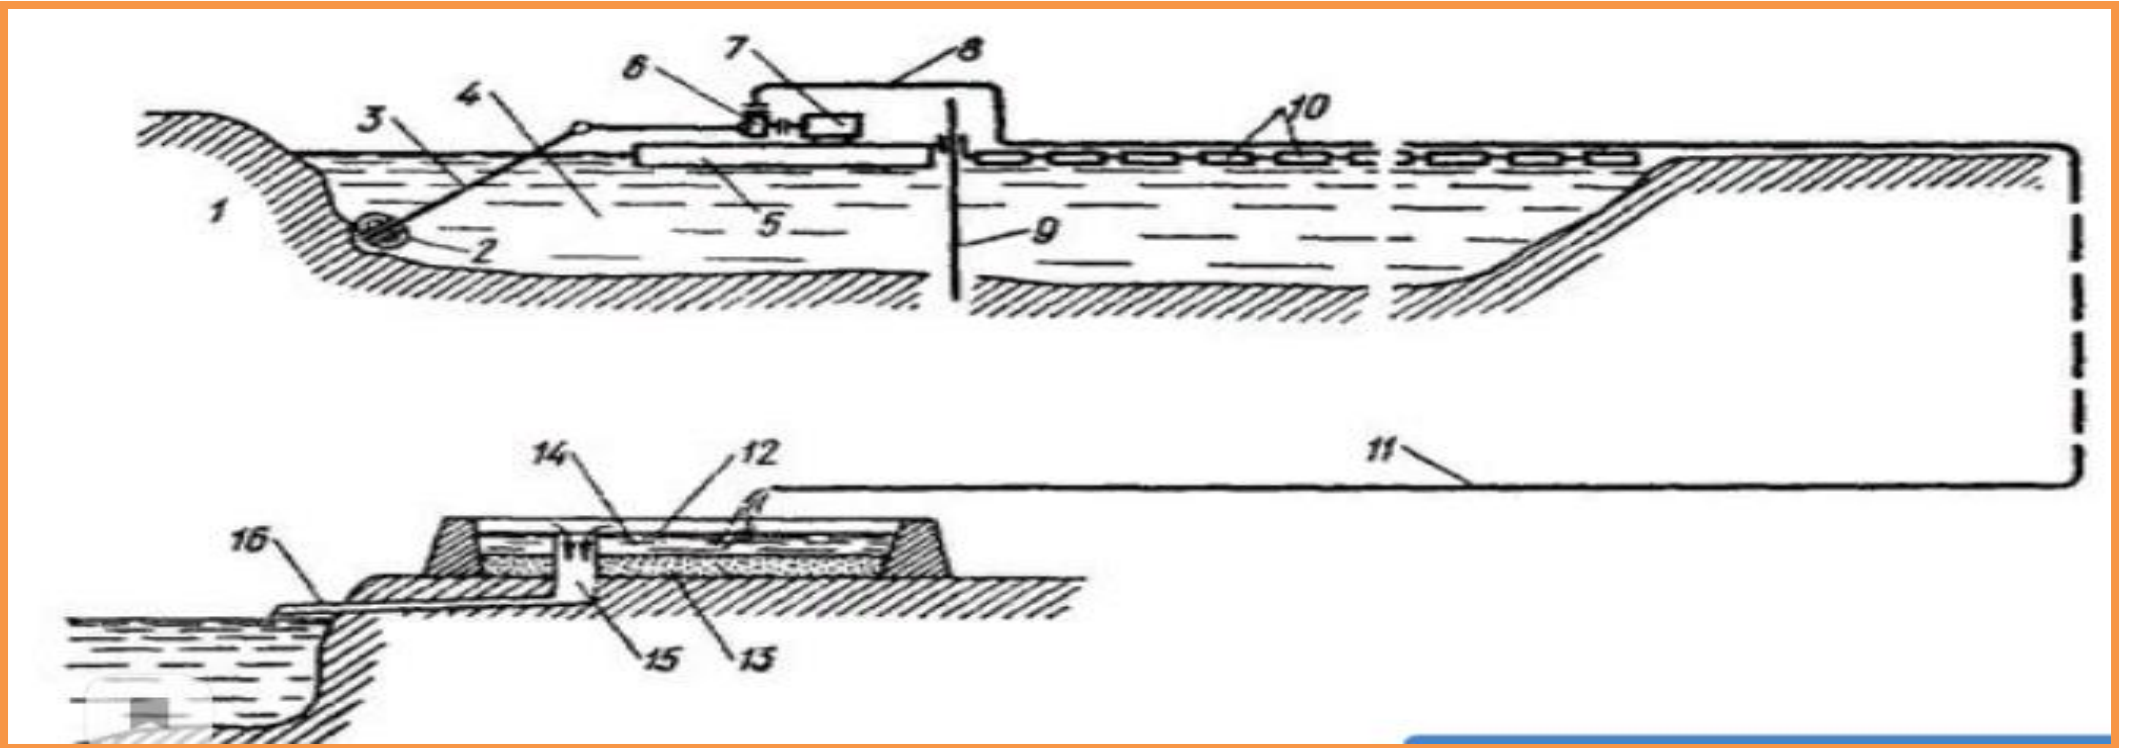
Общая схема земснарядной разработки грунта: 1 – забой; 2 – рыхлитель; 3 – всасывающее устройство; 4 – водоем; 5 – понтон; 6 – грунтовой насос; 7 – двигатель грунтового насоса; 8 – напорный пульповод; 9 – свайный аппарат; 10 – поплавки для удержания пульповода; 11 – сухопутная часть пульповода; 12 – карта; 13 – осевший грунт; 14 – осветленная вода; 15 – шандорный колодец; 16 – лоток для сбора осветленной воды
